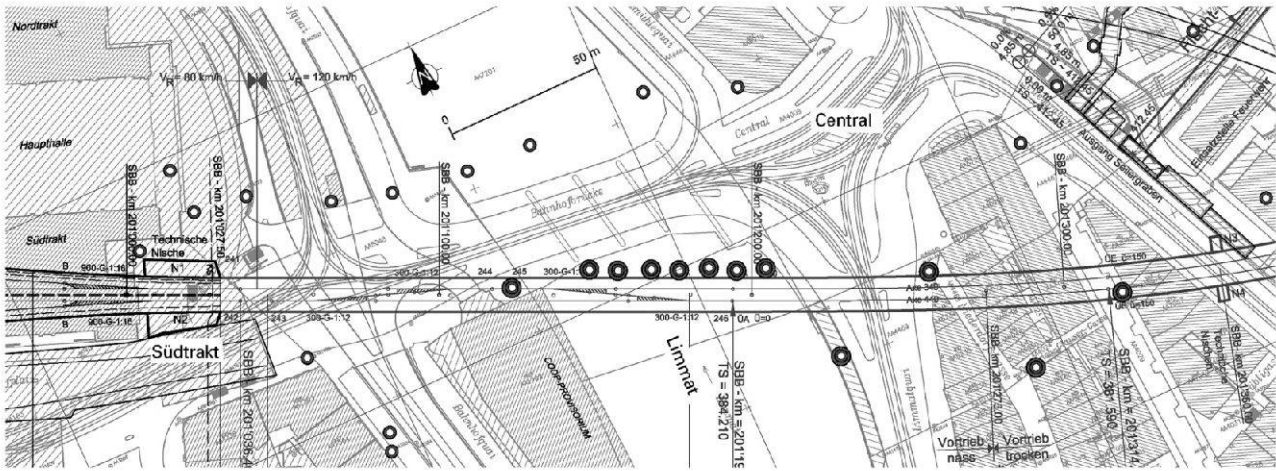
Weinbergtunnel, Abschnitt Central (rechts) bis Schacht Südtrakt beim Hauptbahnhof Zürich: Zur Prognose verfügbare Kernbohrungen (dicke Kreise = erstellt für DML).
